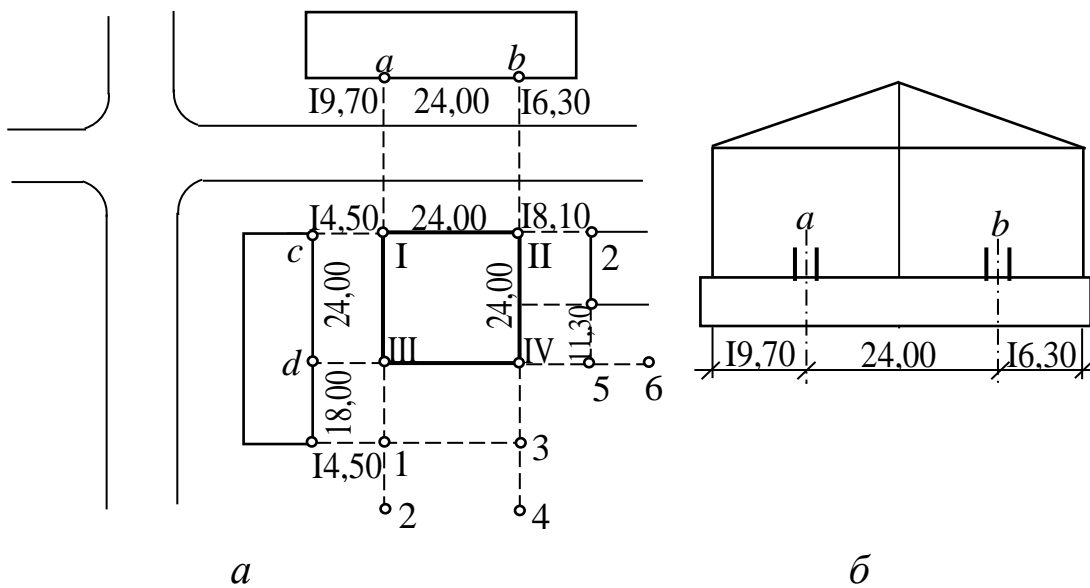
Схема закріплення головних та допоміжних осей промислового будинку: 1 – колони; 2 – точки закріплення головних осей; 3 – точки закріплення допоміжних осей.
